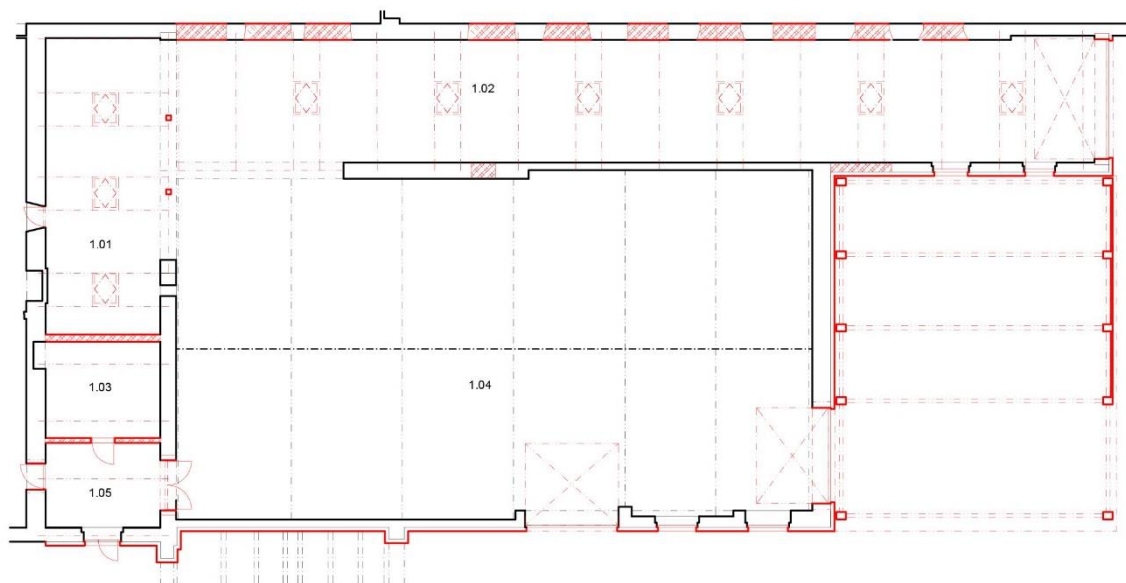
Půdorysné schéma bouracích prací - 1.NP
